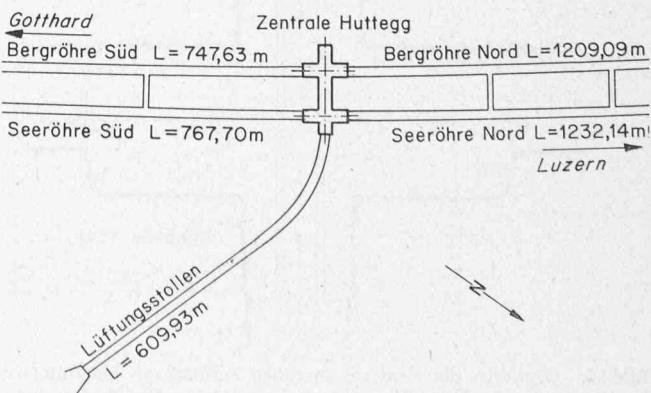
Grundrissskizze des Baulosen Hutegg mit Lüftungsstollen, Lüftungszentrale, Seeröhre und Bergröhre
